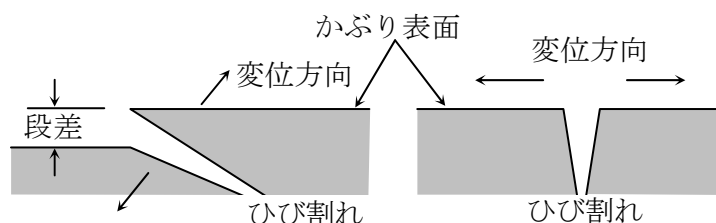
剥離ひび割れと軸方向ひび割れ概念図
